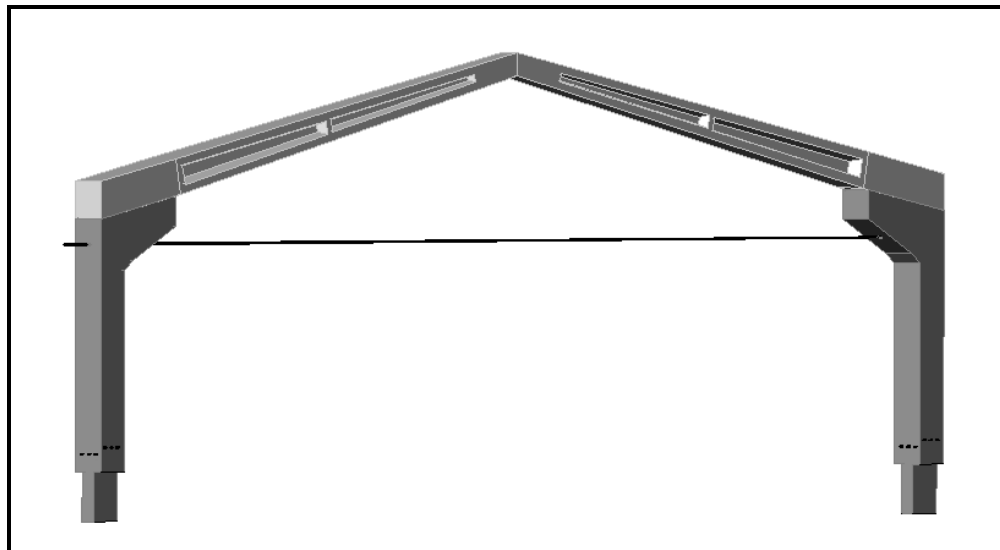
Croqui do Pórtico em 3(três) dimensões
